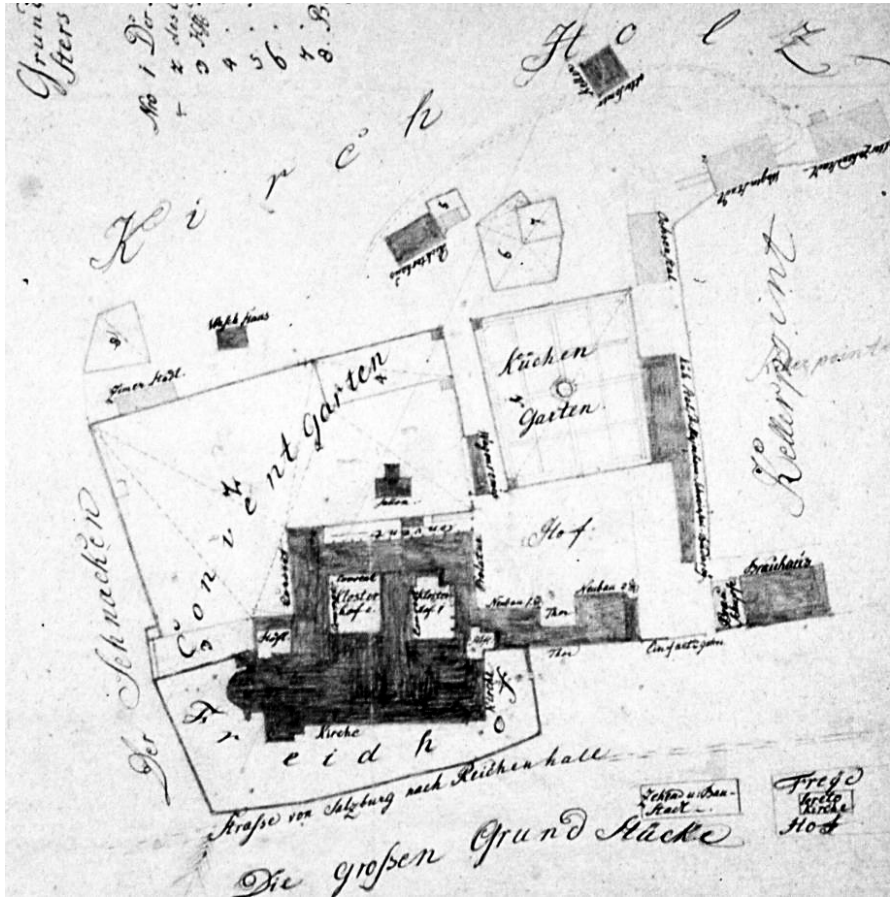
Grundriss der Klosteranlage, zweite Hälfte 18. Jahrhundert. BayHStA, PS 9068.
